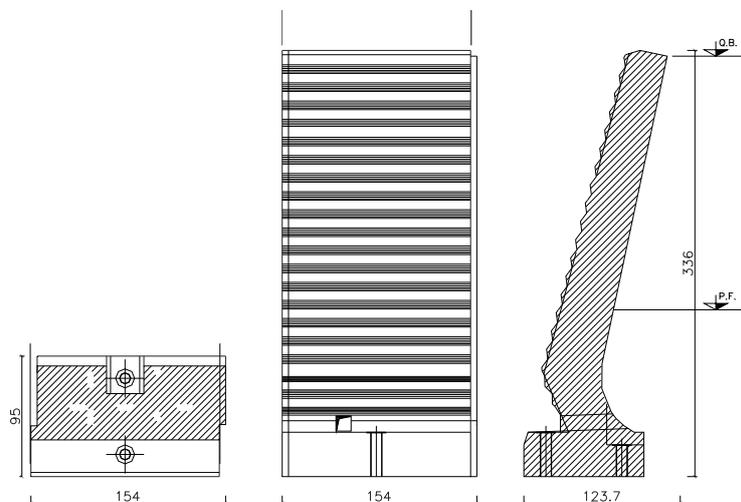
Pianta a livello fondazioni, prospetto e sezione laterale del modulo BM130
